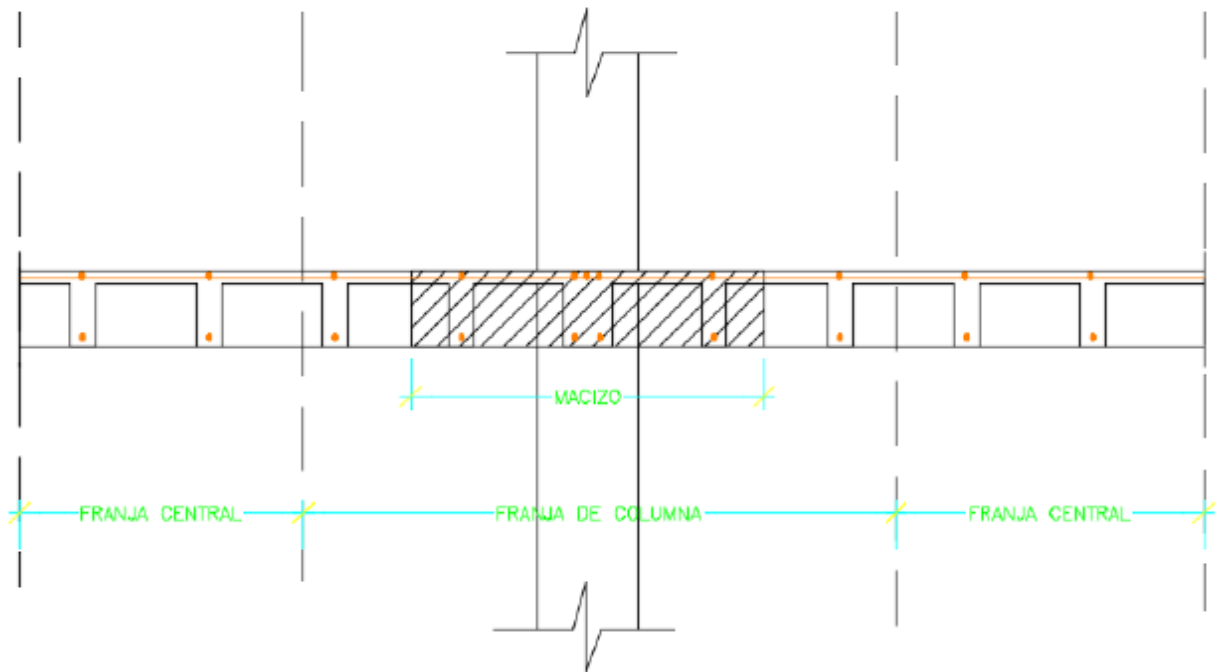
Detalle general de la losa nervada con macizo. Fuente: (Loor, 2015)
